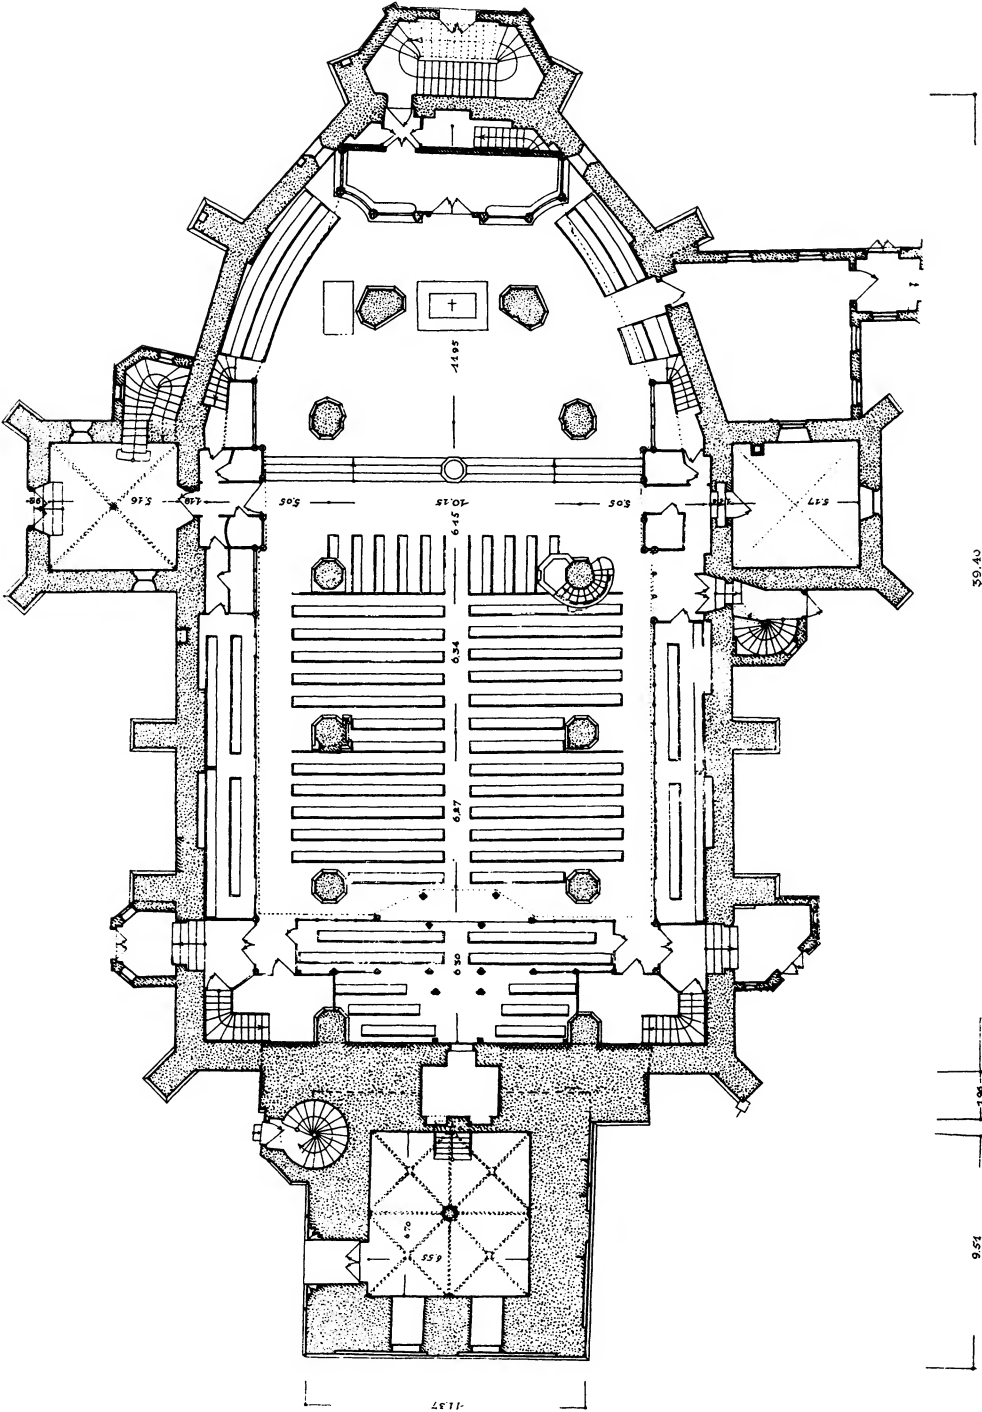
Grundriß der St. Marienkirche (Maßstab 1:300)
